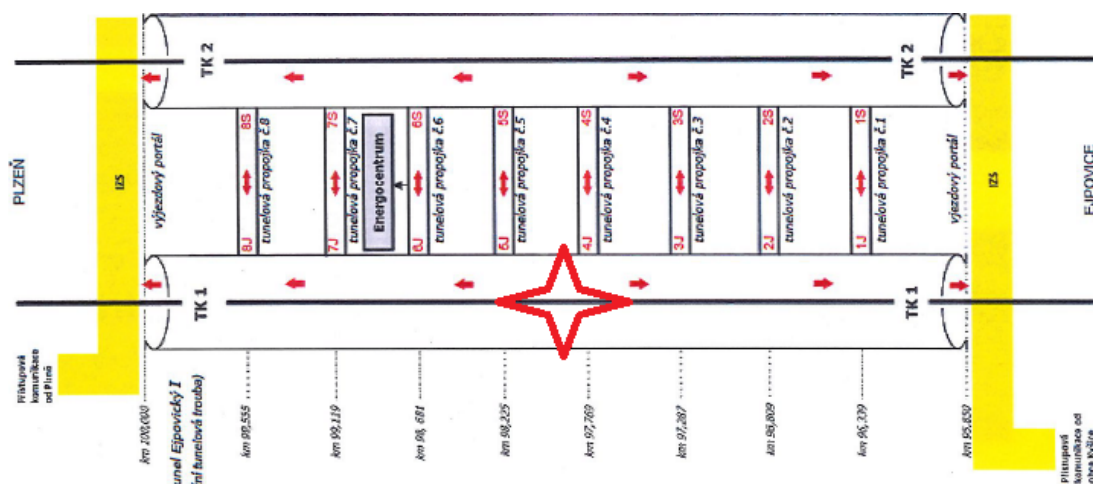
Portál Chlum – rozdělení místa zásahu³⁹
